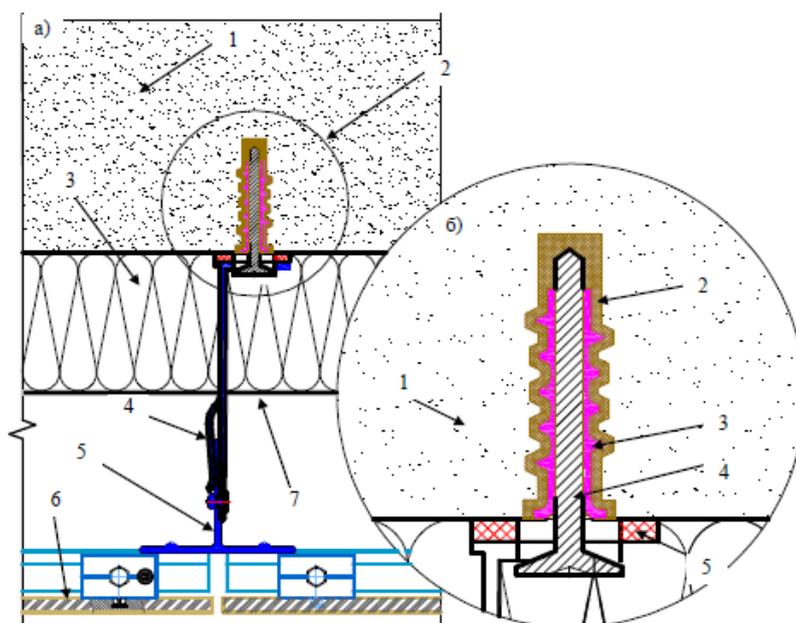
Принципиальный узел крепления наружного фасада на ограждающую конструкцию из пористого материала с помощью усовершенствованного анкерного крепления
